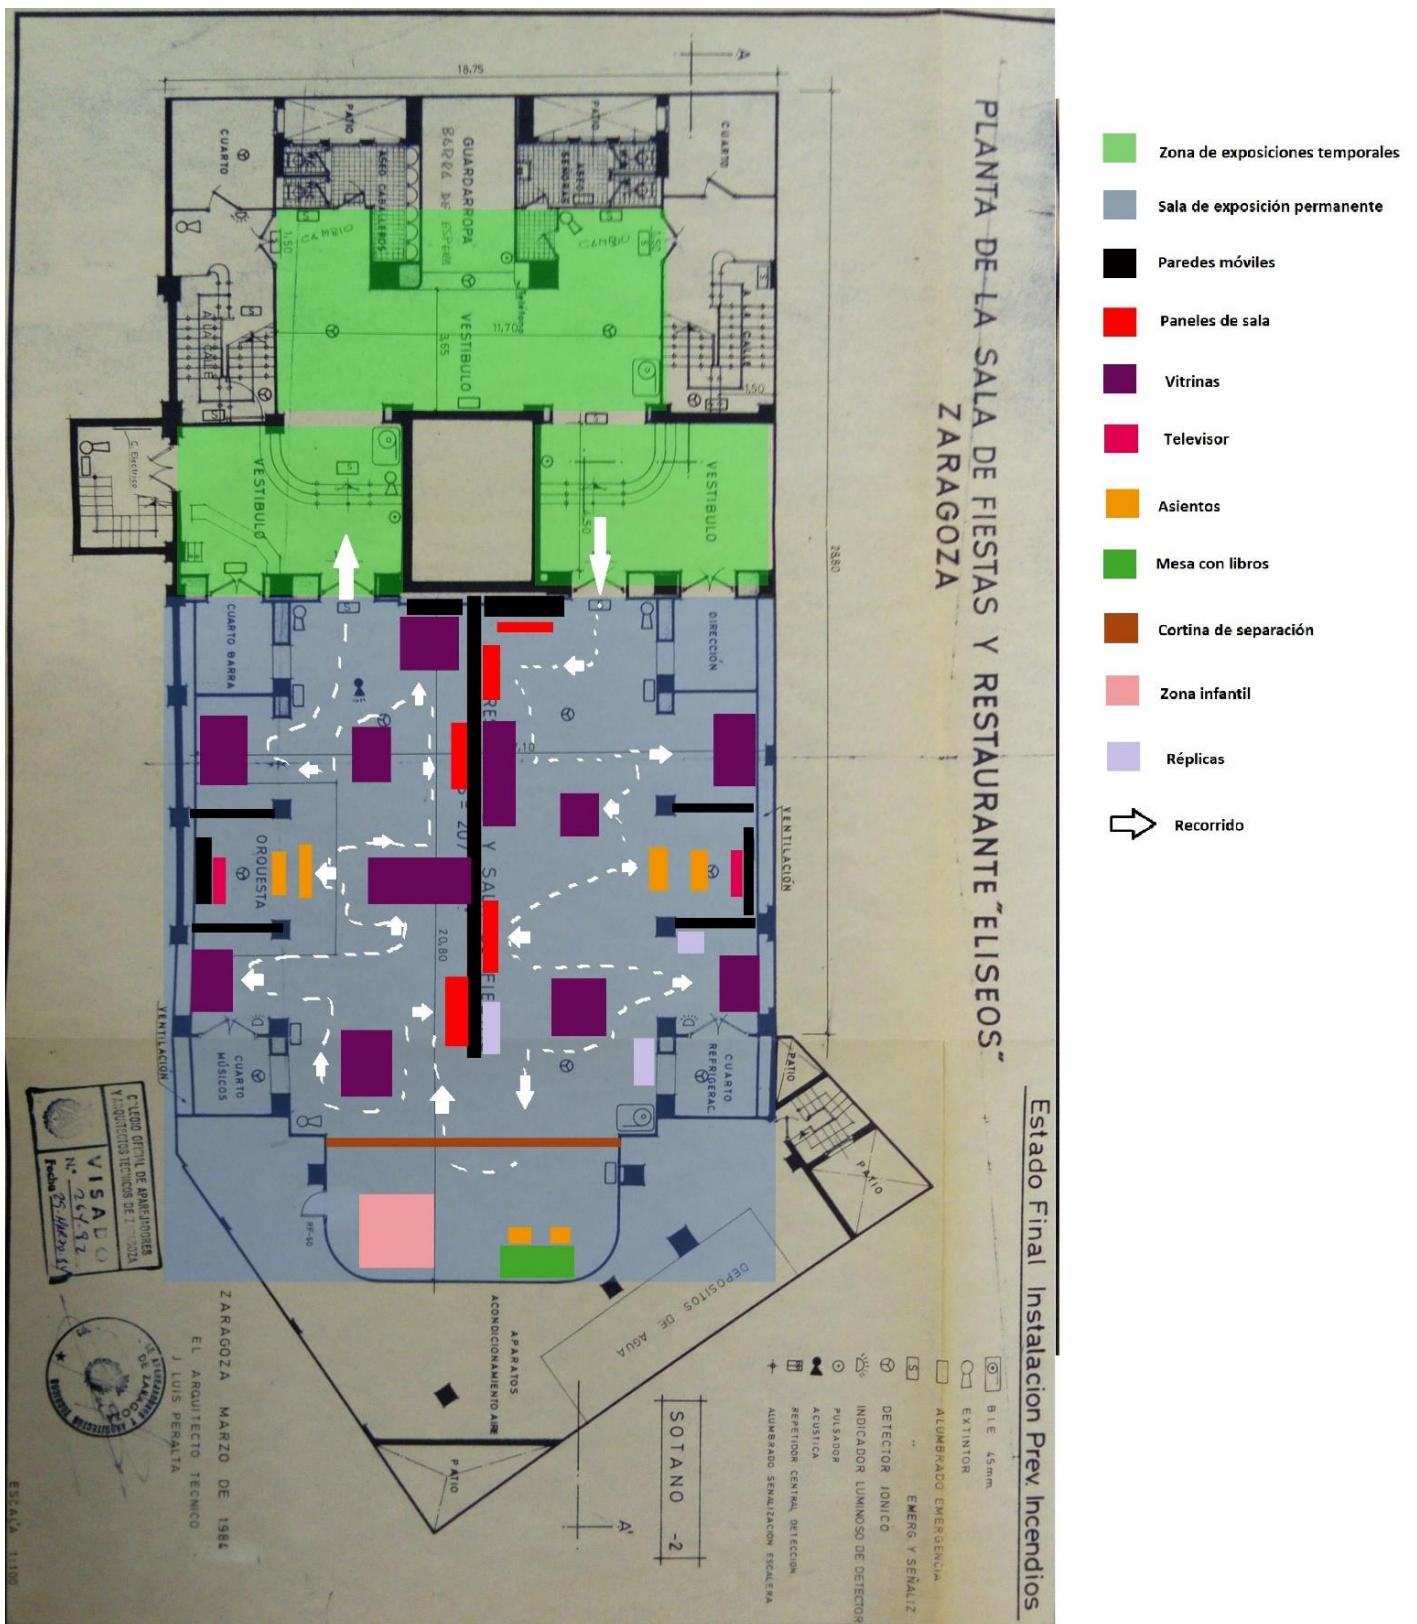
Planta del sótano 2 y plano de la exposición permanente
